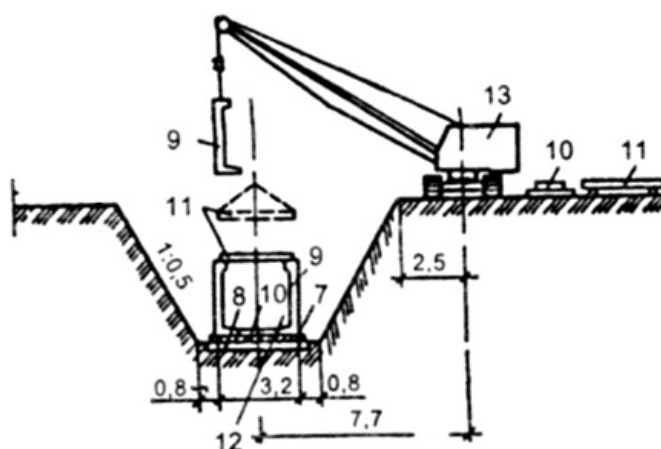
Схема установки сборных элементов при монтаже тоннеля автокраном
